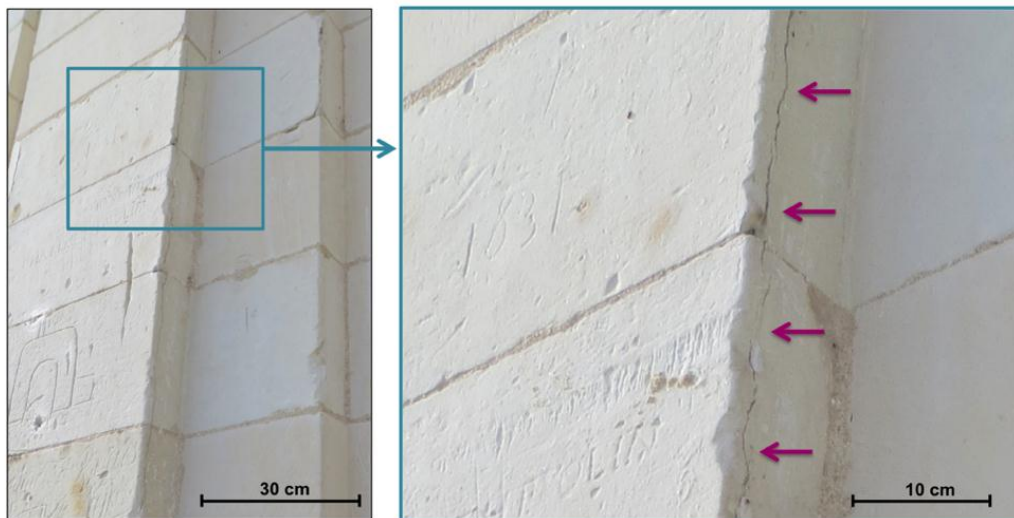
EXEMPLE DE FISSURES SUR LE COTE D'UN PILASTRE
